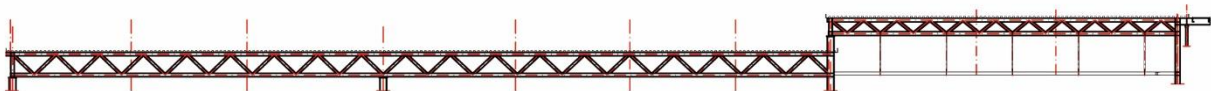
Alzado de celosía típica en cubierta del edificio Nuevo.
